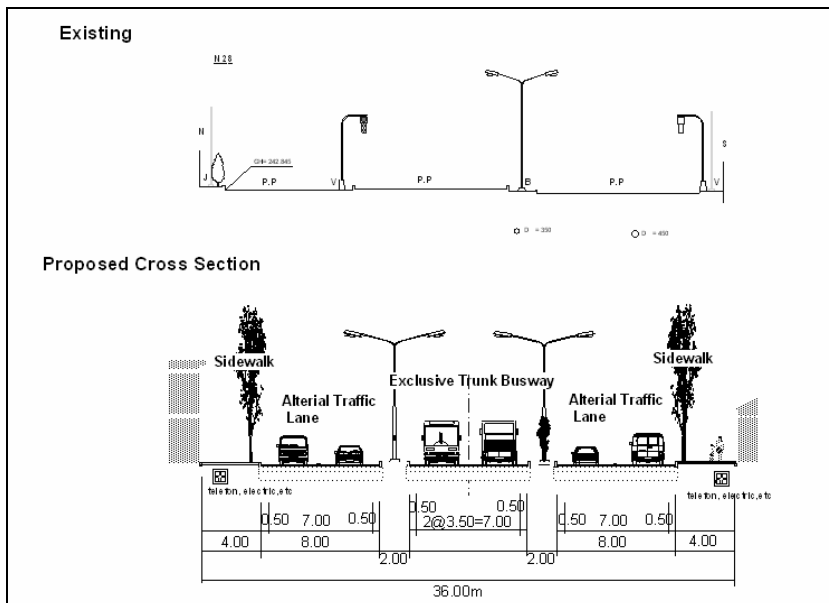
Sección Transversal Típica 36m (Tipo C)
